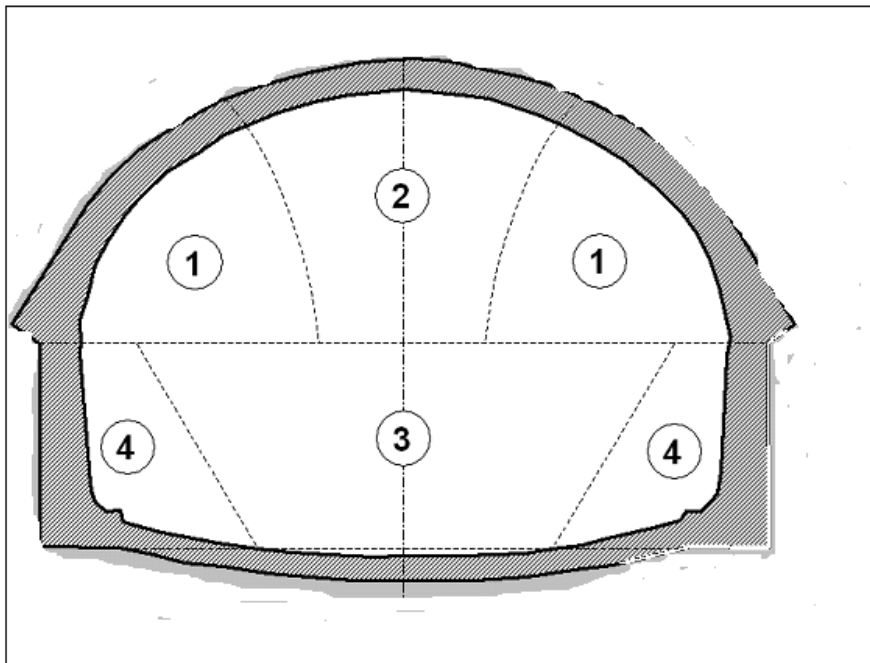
Sections divisées (excavées par ordre de 1 à 4)
